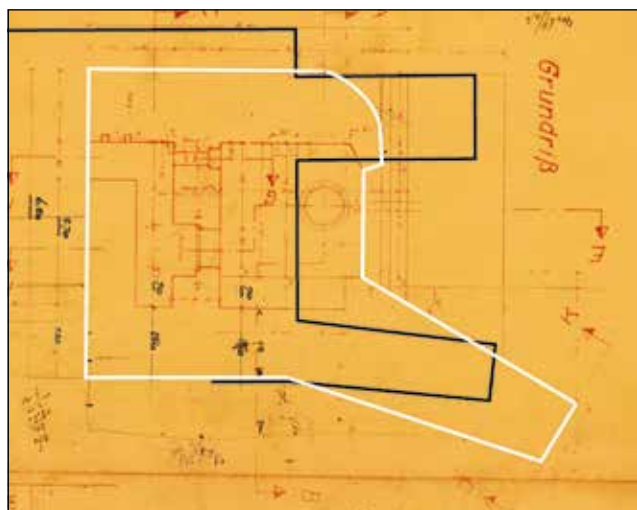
Montaje sobre un plano original de una casamata modelo 667, escala 1:50, donde se han representado las plantas de las dos construcciones de Baleines. En blanco, el perfil exterior de una estructura de esta tipología; en negro, el perfil con las medidas convertidas a la misma escala de la otra construcción que se encuentra en el perímetro exterior del faro. Se observa claramente como no coinciden ni en forma ni dimensiones. La presencia de dos muros de flanqueo parece indicar que se podría tratar de una adaptación local de una tipología de casamatas con dos troneras, las cuales tienen una distribución irregular a lo largo del Muro Atlántico (colección autor).
